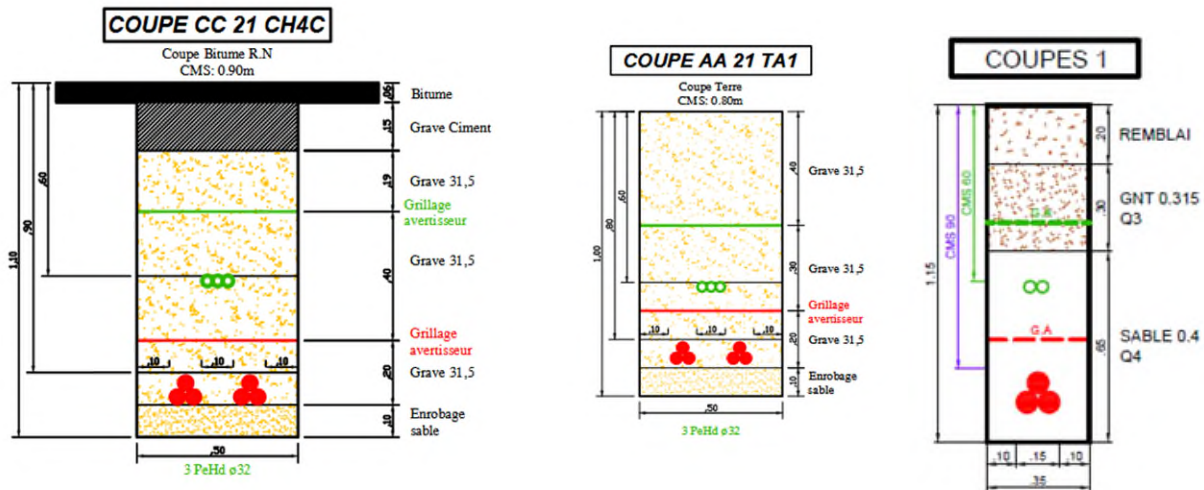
PLAN DE COUPE DES TRANCHÉES POUR L'INSTALLATION DES CÂBLES SOUTERRAINS
